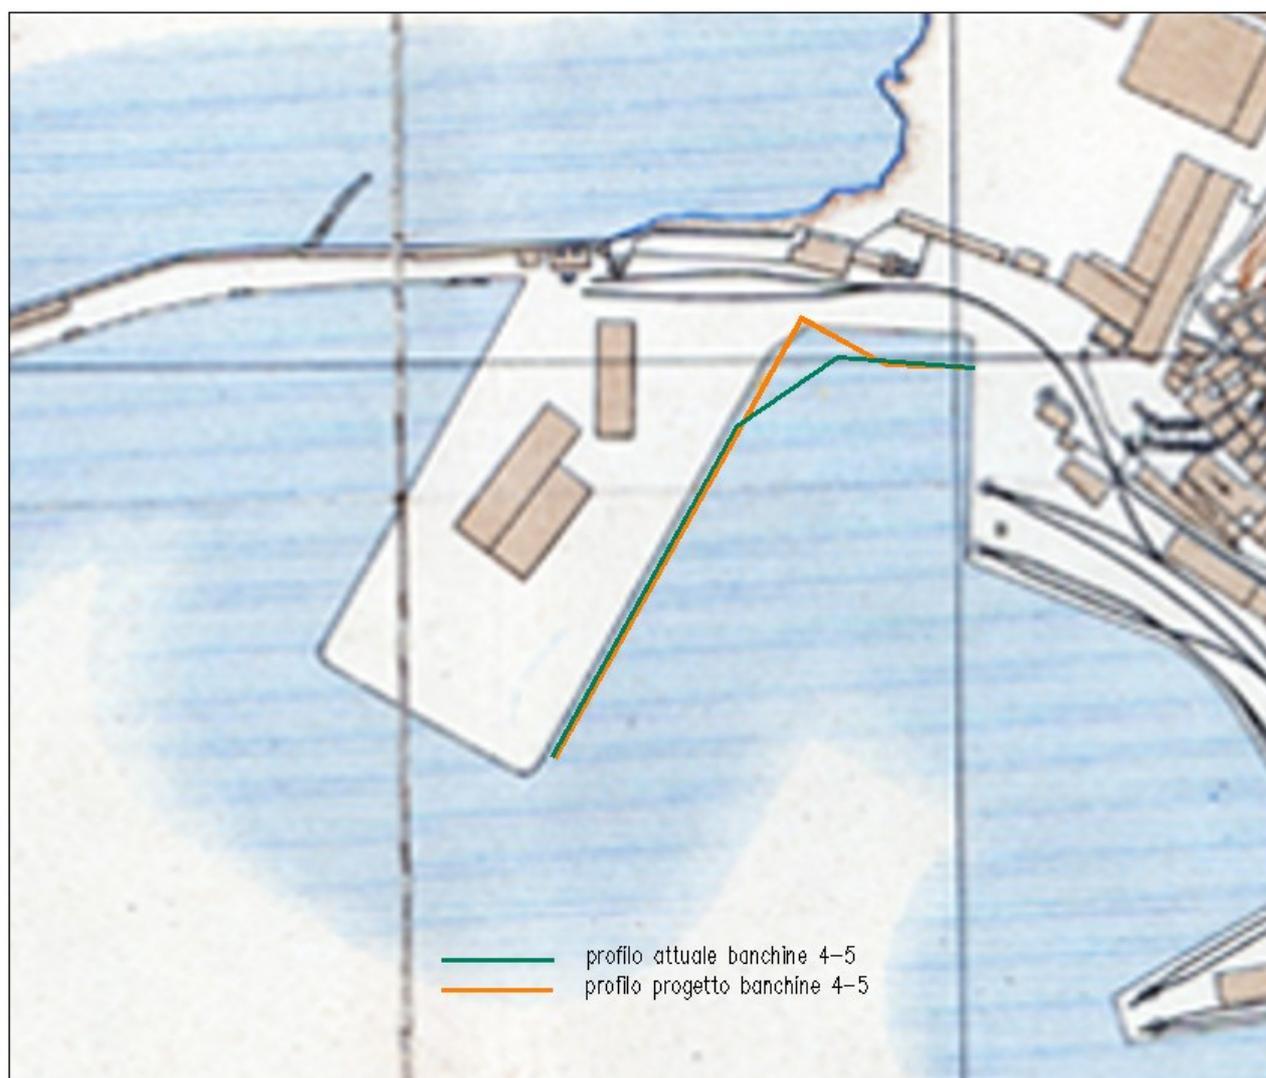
Sovrapposizione stato di fatto e intervento proposto su stralcio aerofotogrammetrico 1937
